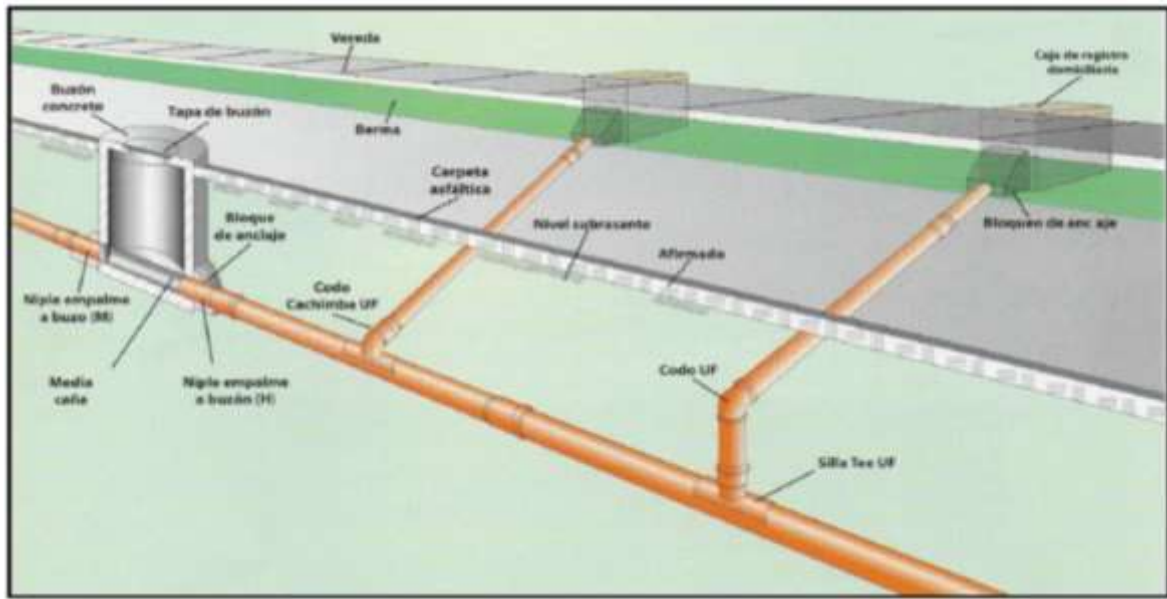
Componentes de un sistema de alcantarillado sanitario.
